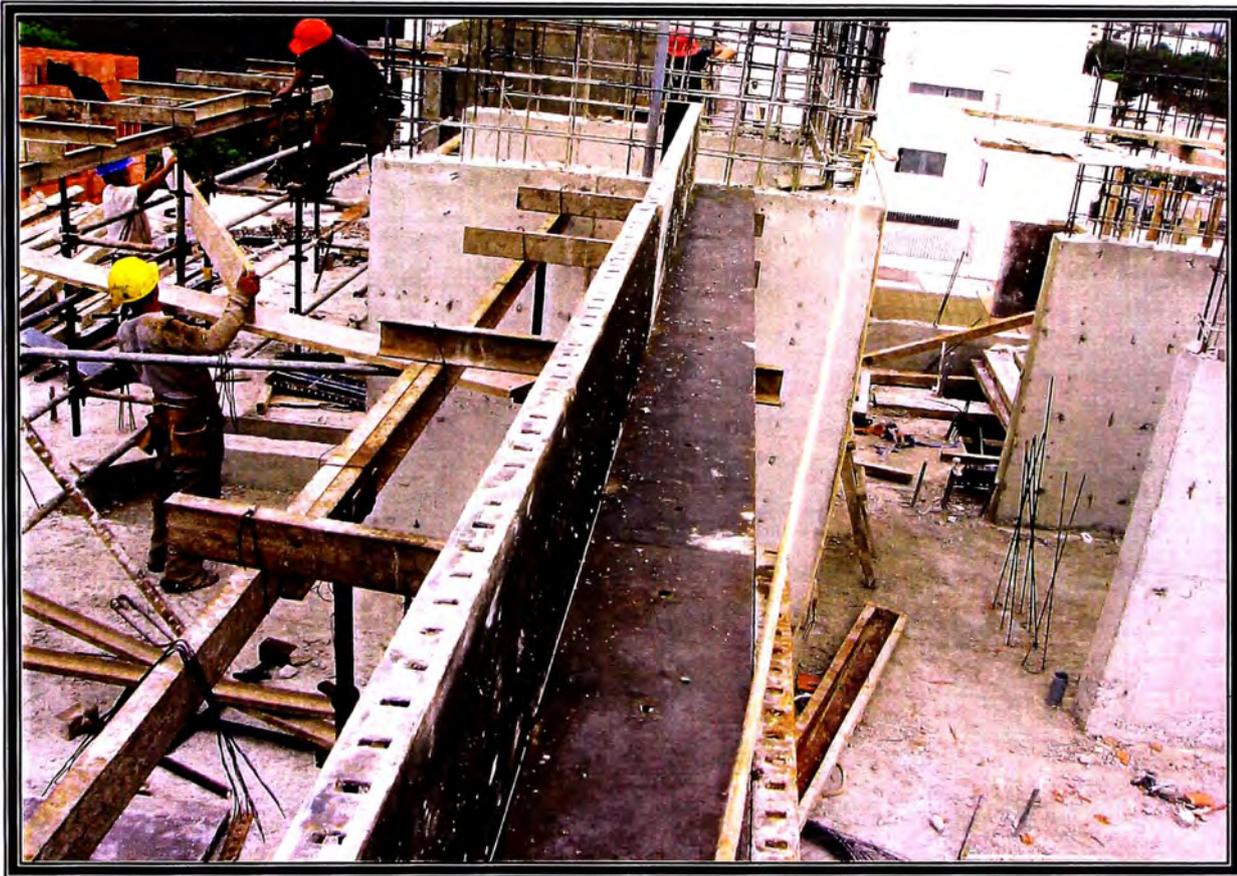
DETALLE DEL ENCOFRADO METALICO EN VIGAS.
